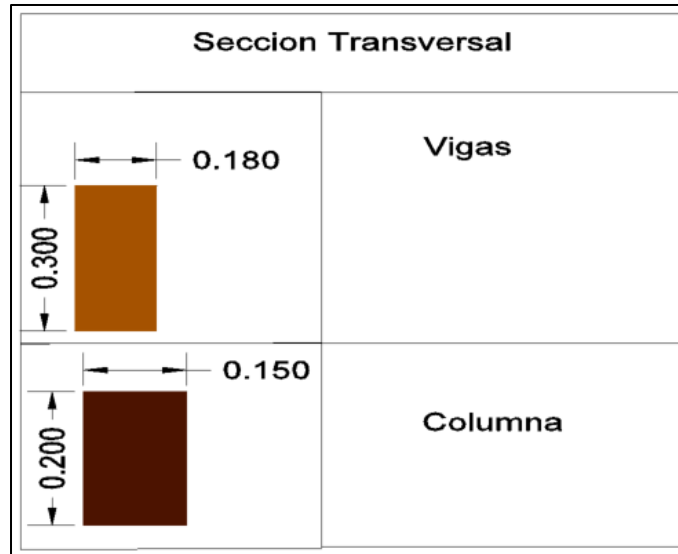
Dimensiones de vigas y columnas Ref. (Silva & Valencia, 2023)
